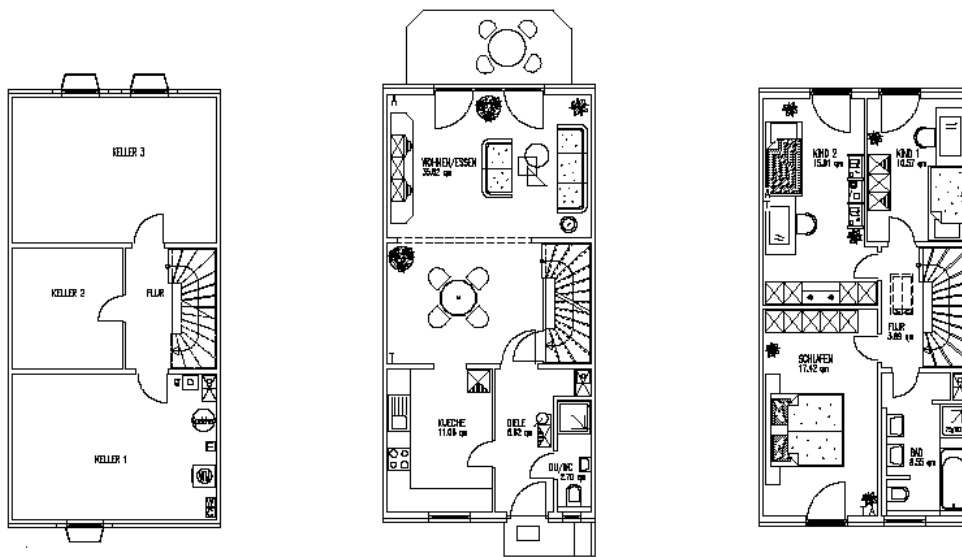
Beispielhafter Grundriss eines Reihenhauses (von links: UG, EG, OG)
